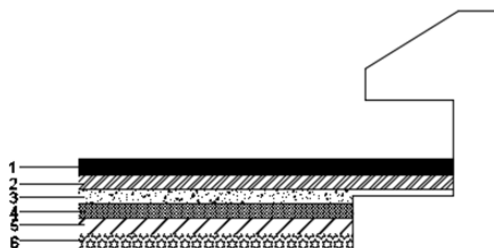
Détail des constituants du plancher terrasse inaccessible
